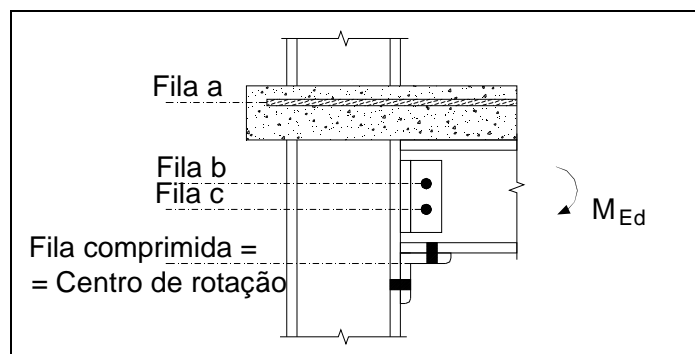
Ligação mista com cantoneiras de assento e alma.
